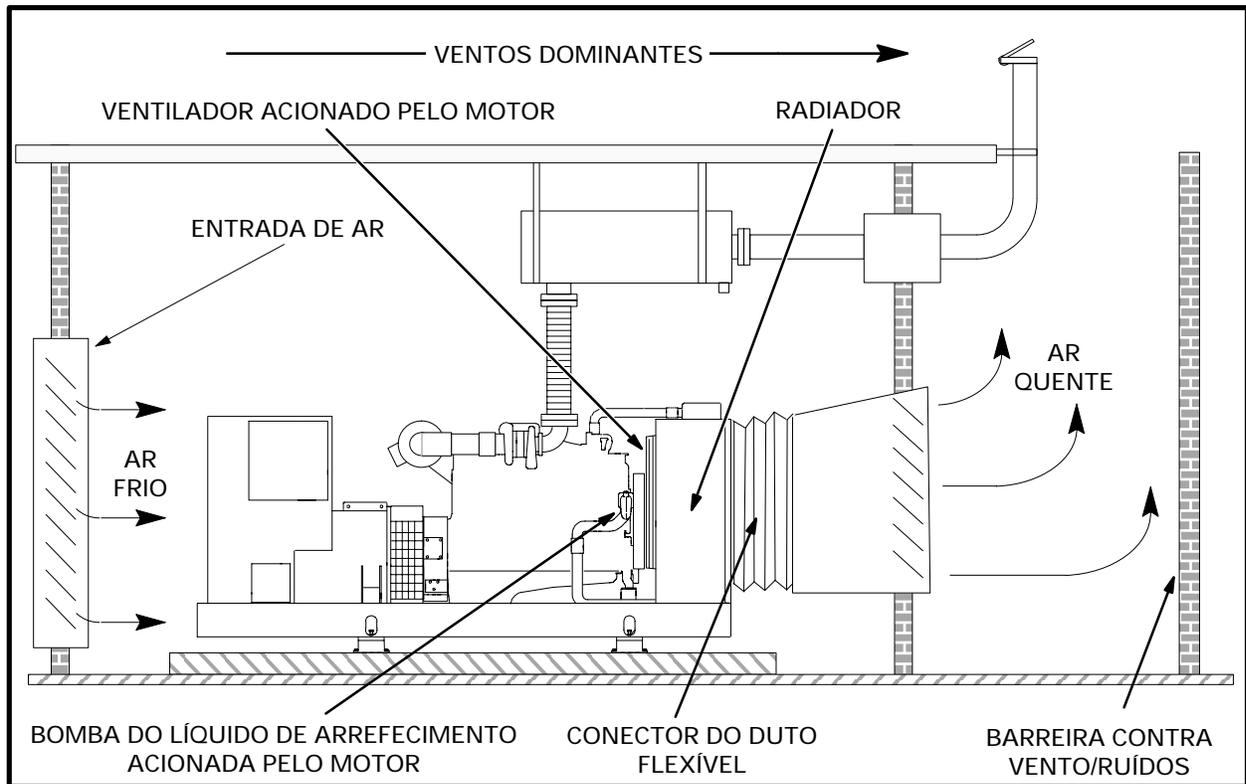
Arrefecimento do Radiador Montado na Fábrica
